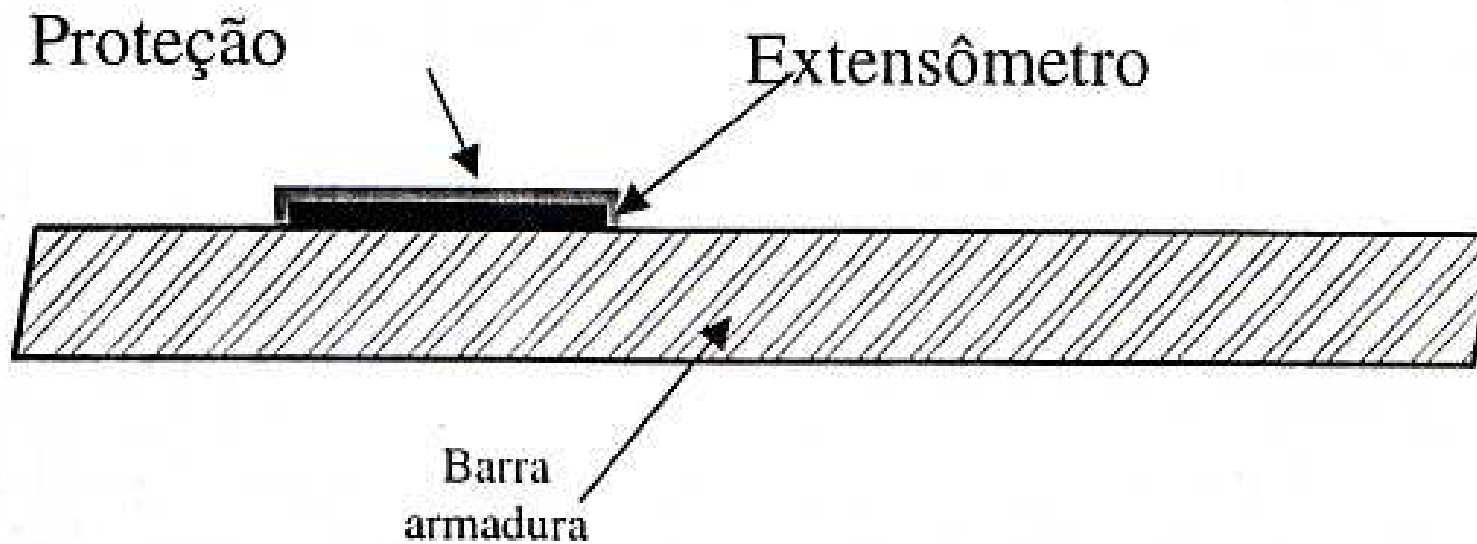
Detalhe da proteção mecânica sendo aplicada a um extensômetro.
